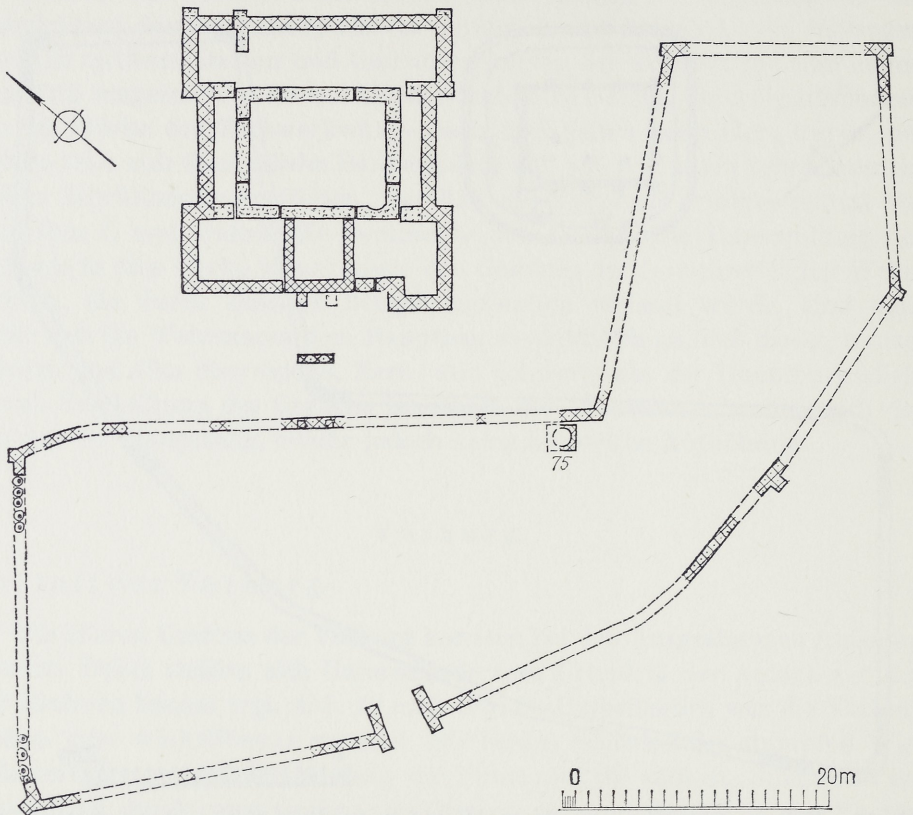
Holtrop. Grundrisse der Bauten A und B der Hauptburg und der Palisade der Vorburg. Pfosten einer Brücke zwischen Haupt- und Vorburg.
